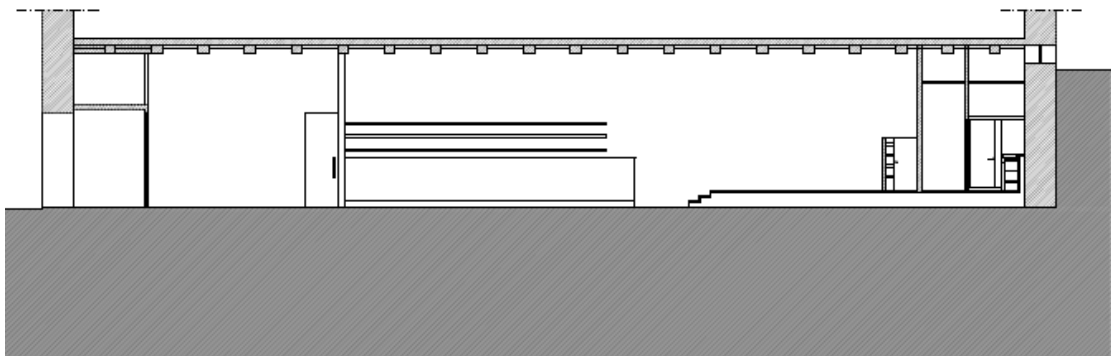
Corte BB - Esc. 1/200 – Autora do projeto
